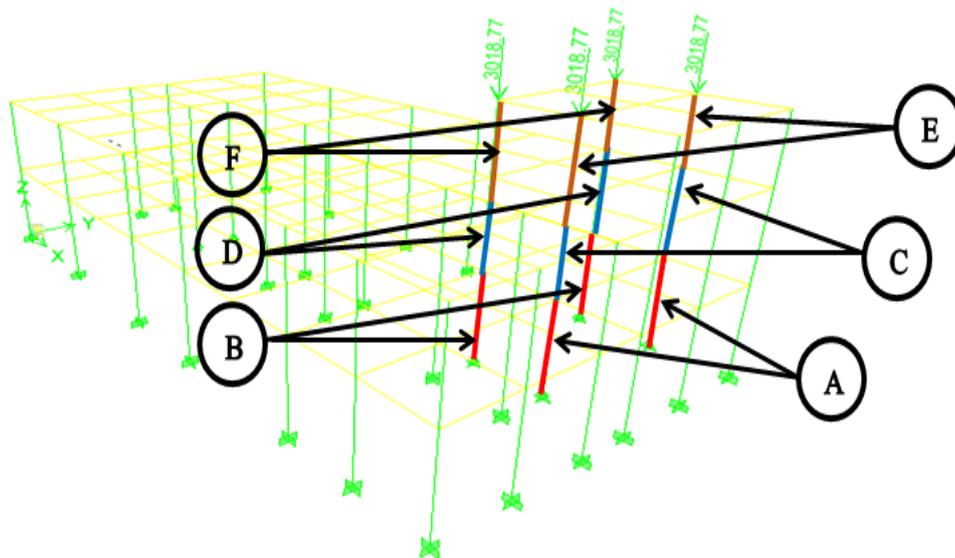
Permodelan bangunan eksisting kolom dan balok dengan penambahan beban tower
